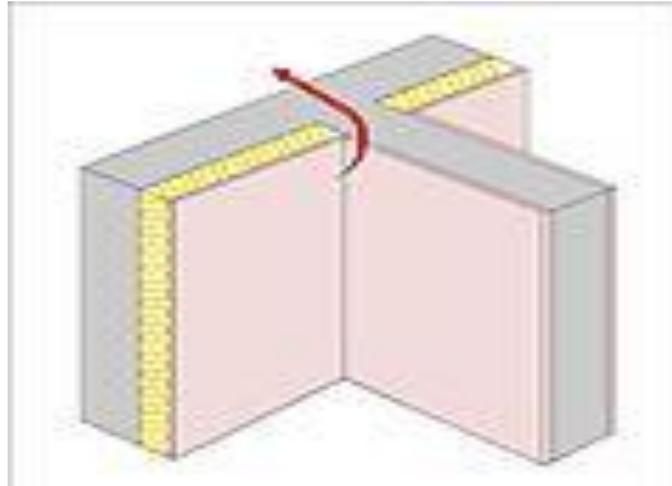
Jonction plancher intermédiaire/mur extérieur.
